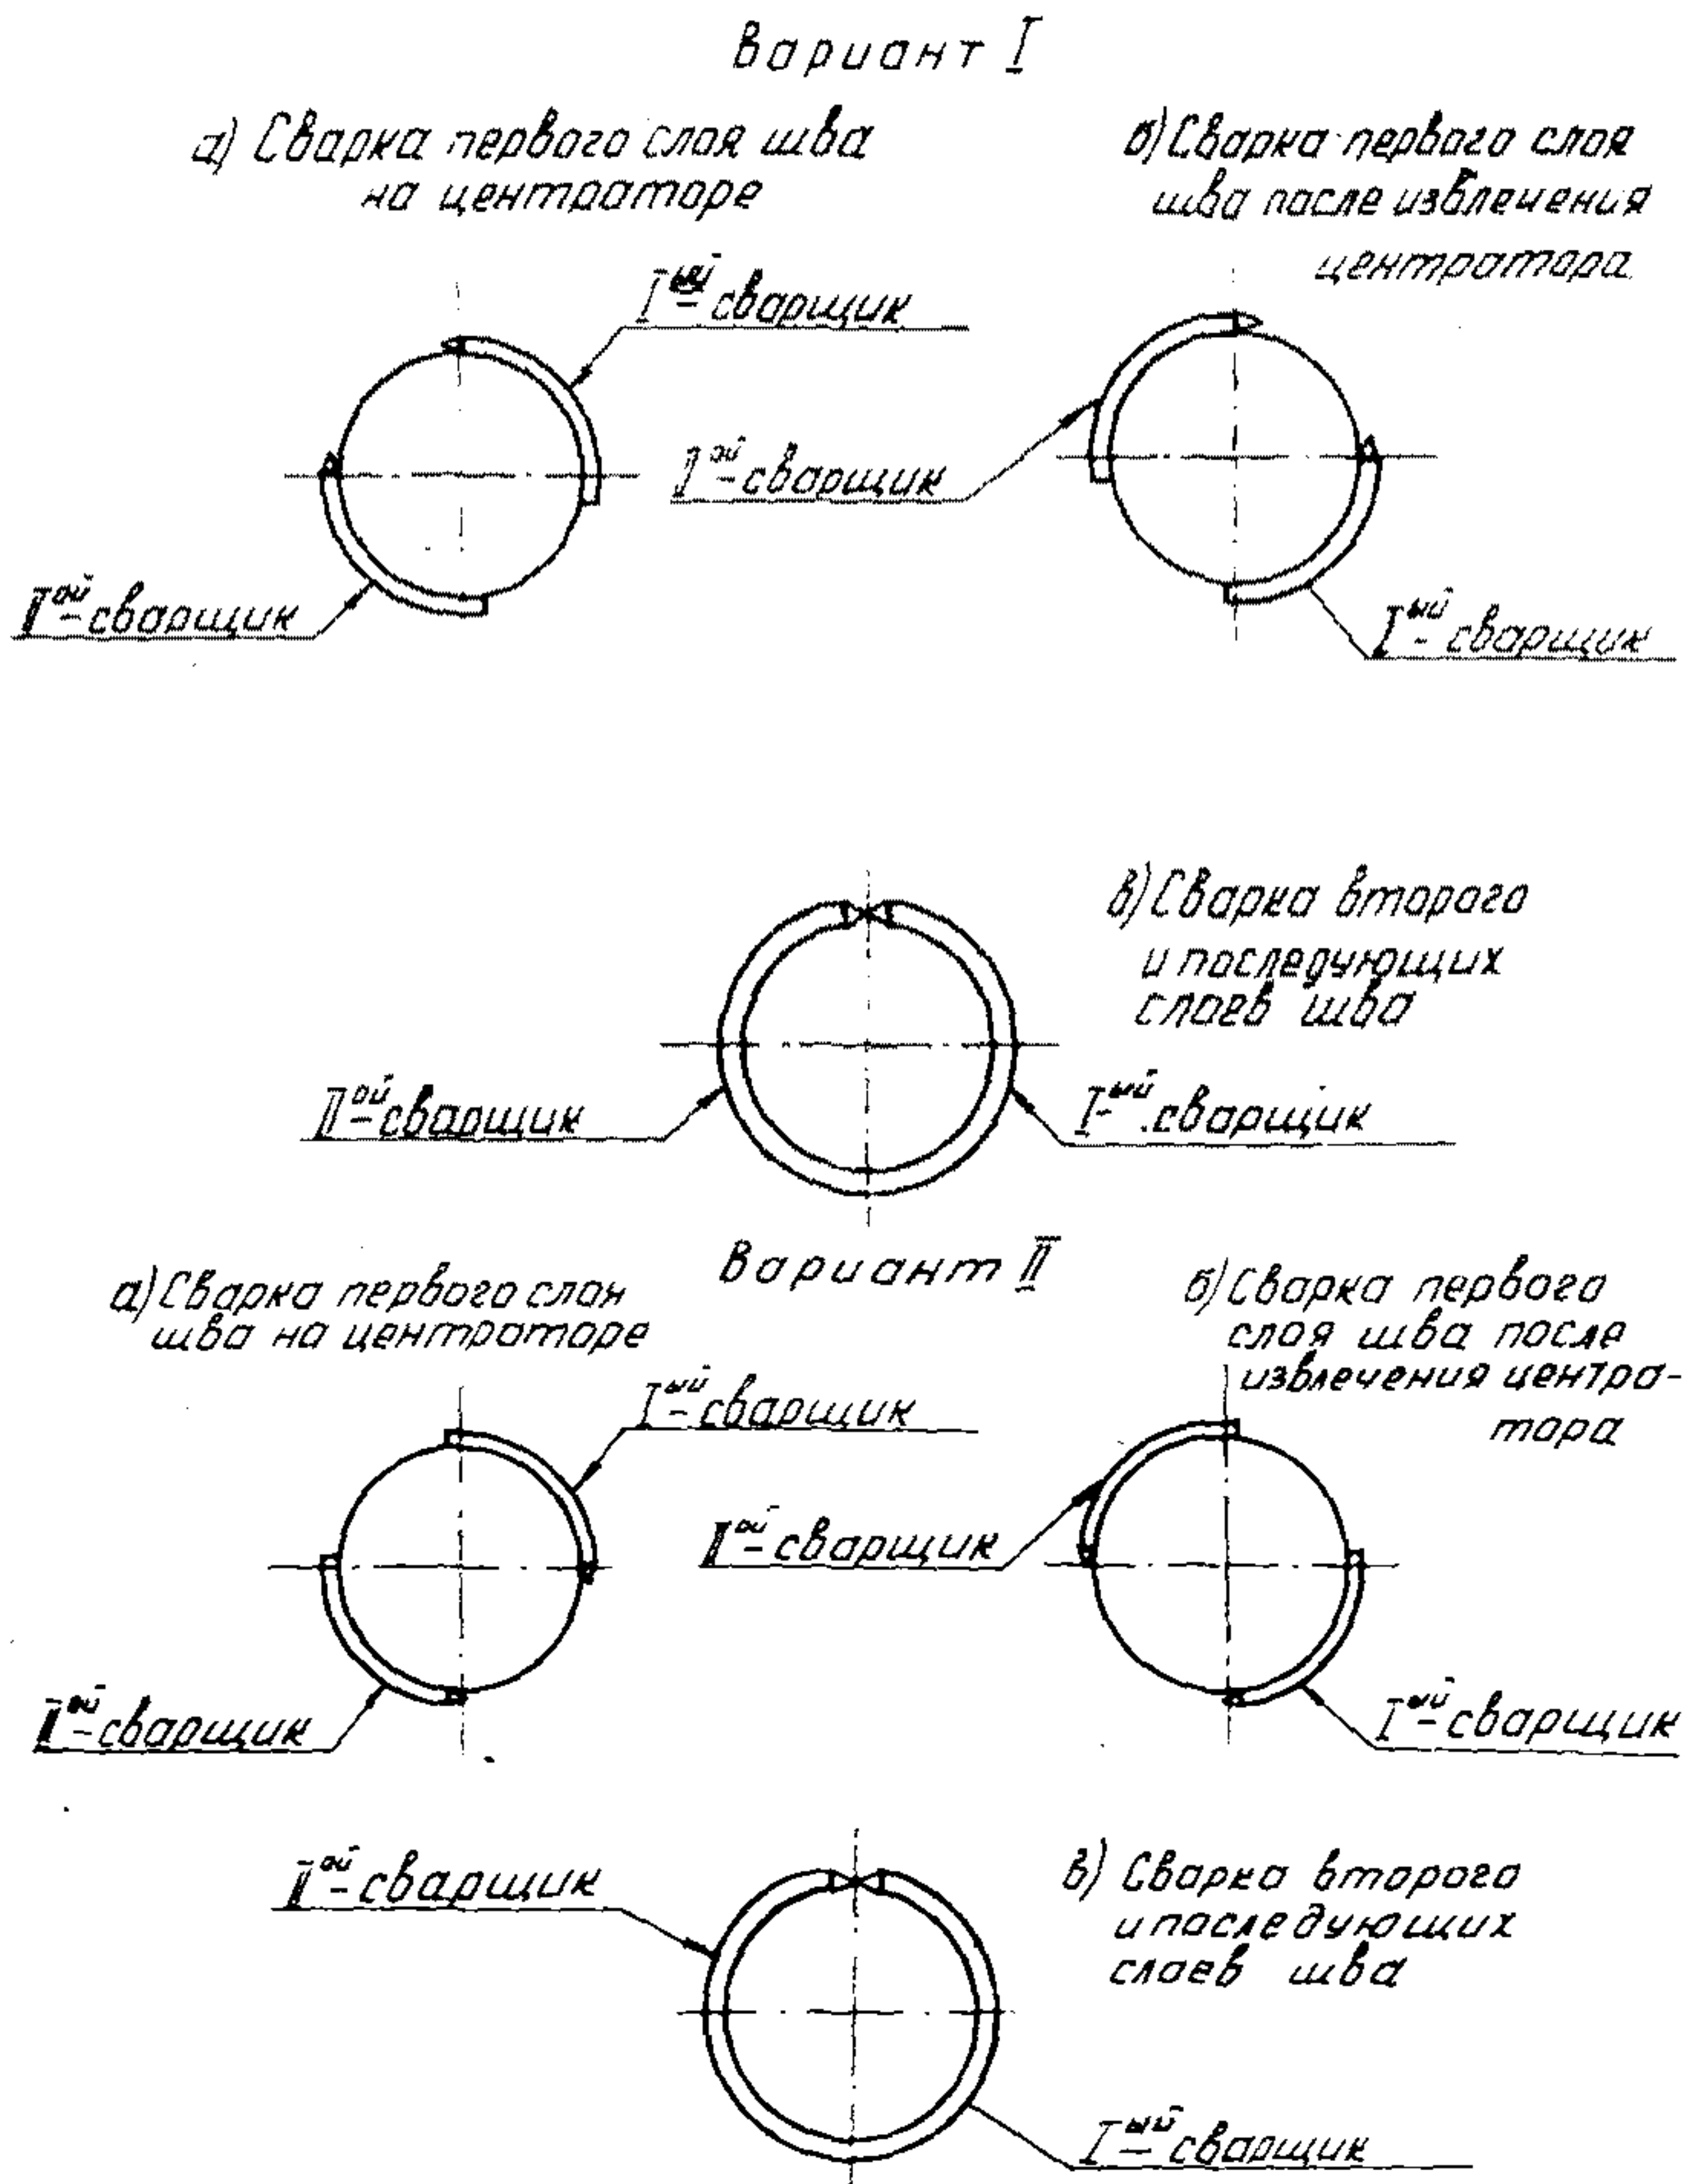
Схема сварки первого и последующих слоев шва по вариантам I и II
